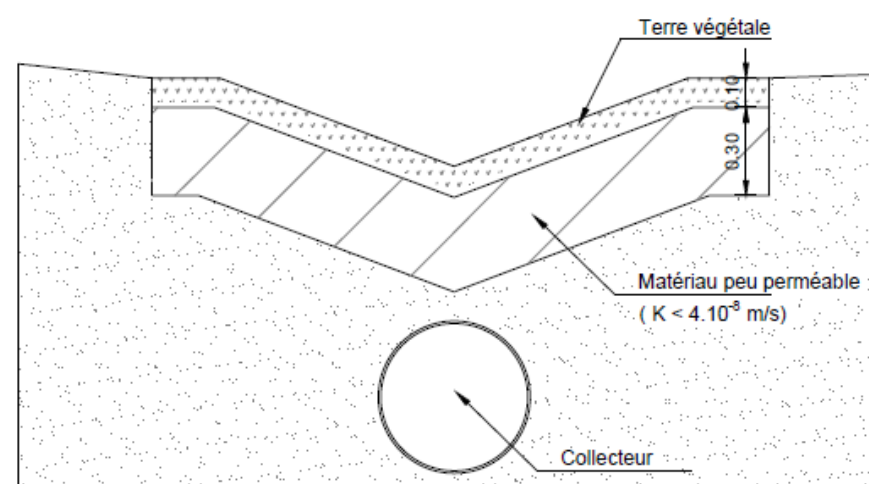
Coupe du dispositif de collecte noue et collecteur (Source : setec, octobre 2016)
